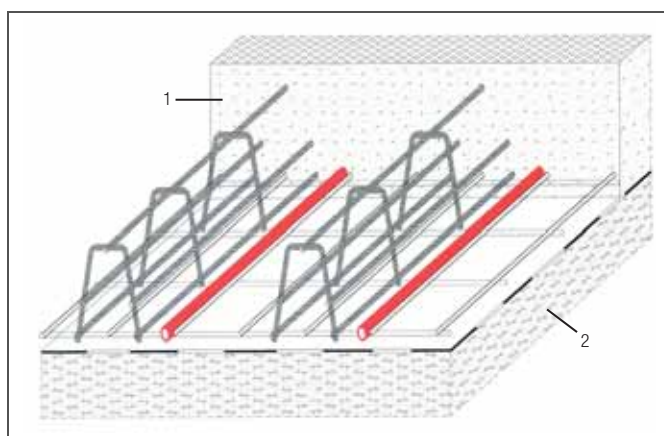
Бетонная плита, армированная стальной арматурой; стандартная конструкция с креплением отопительных труб к нижнему арматурному поясу
